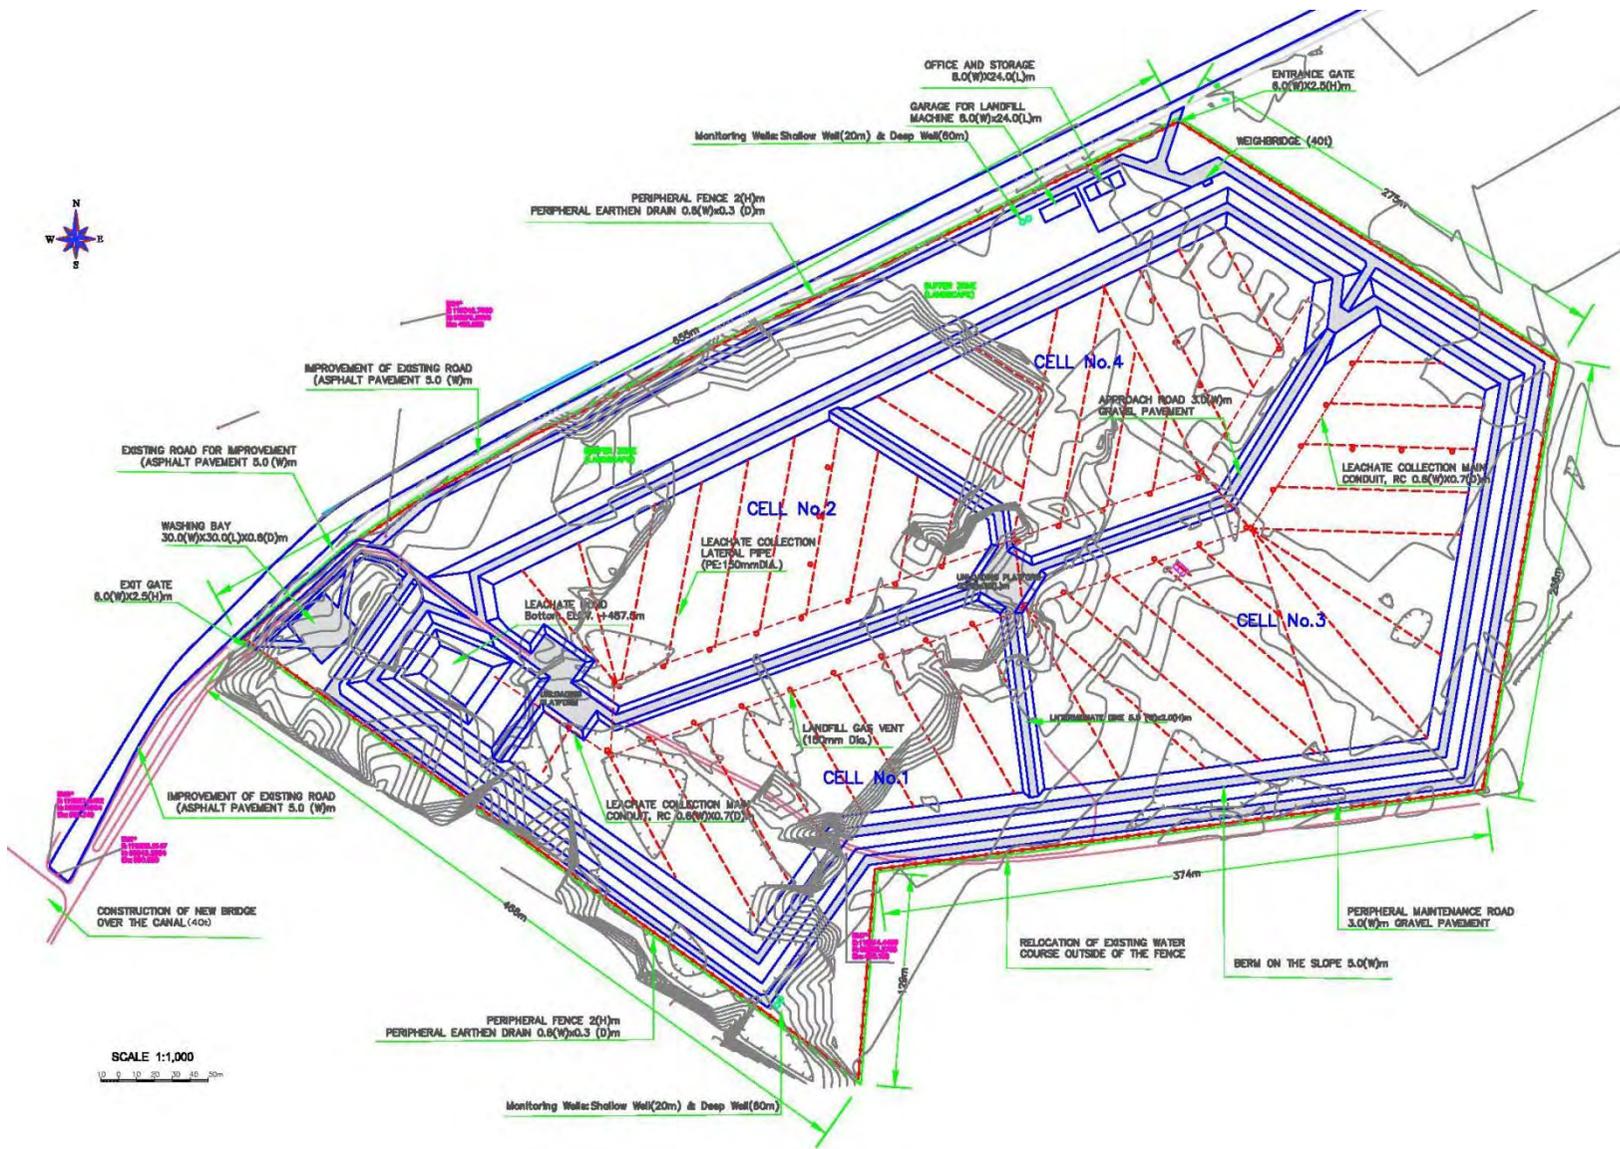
バクライワリ衛生型埋立施設計画平面図
